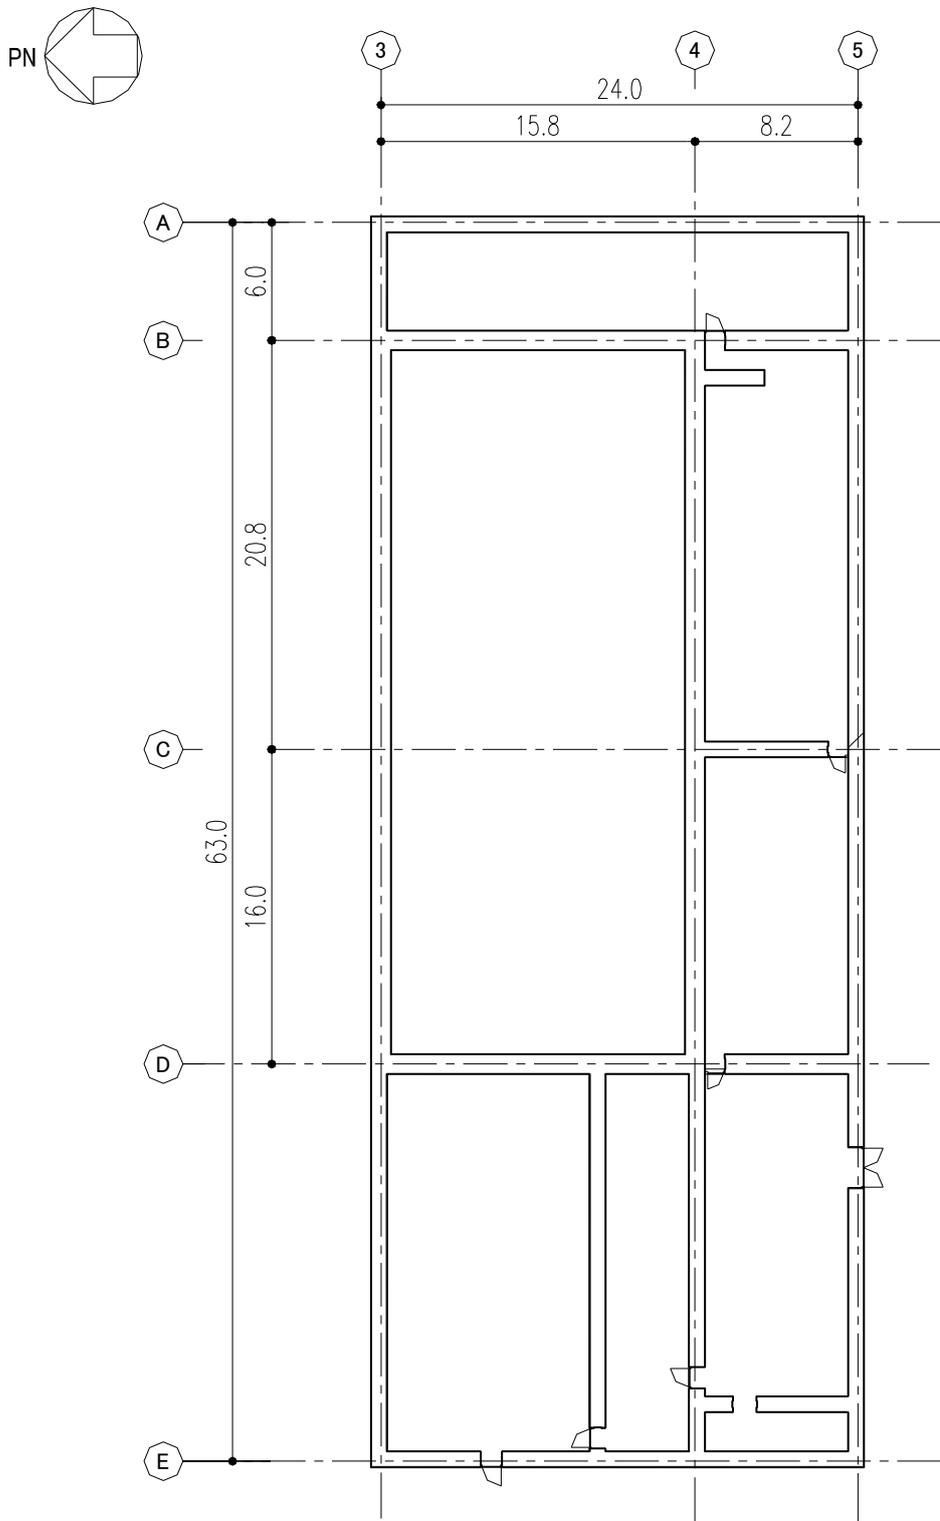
スラッジ棟 建屋平面図 (設計 G.L. +0.2) (単位 : m)
